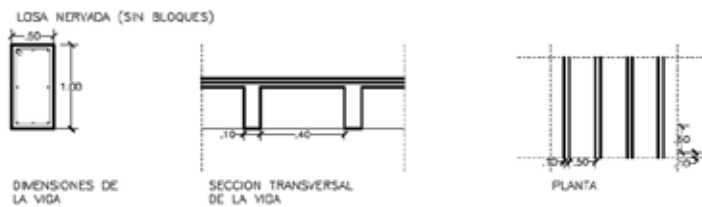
Detalle de Losa Nervada sin Bloques, fuente: La Autora (2017).
